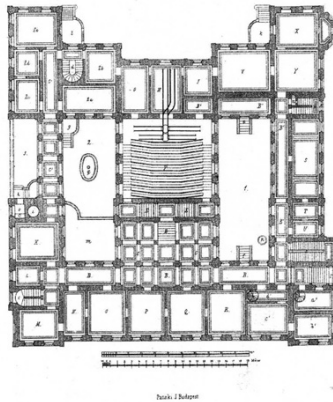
Grundriss des physiologischen Instituts in Budapest (1877). Zentral gelagert ist das Spektatorium. Hinter dem Rednerpult befindet sich das Vorbereitungszimmer, aus dem rollende Tische auf Schienen in den Hörsaal geschoben werden konnten.
